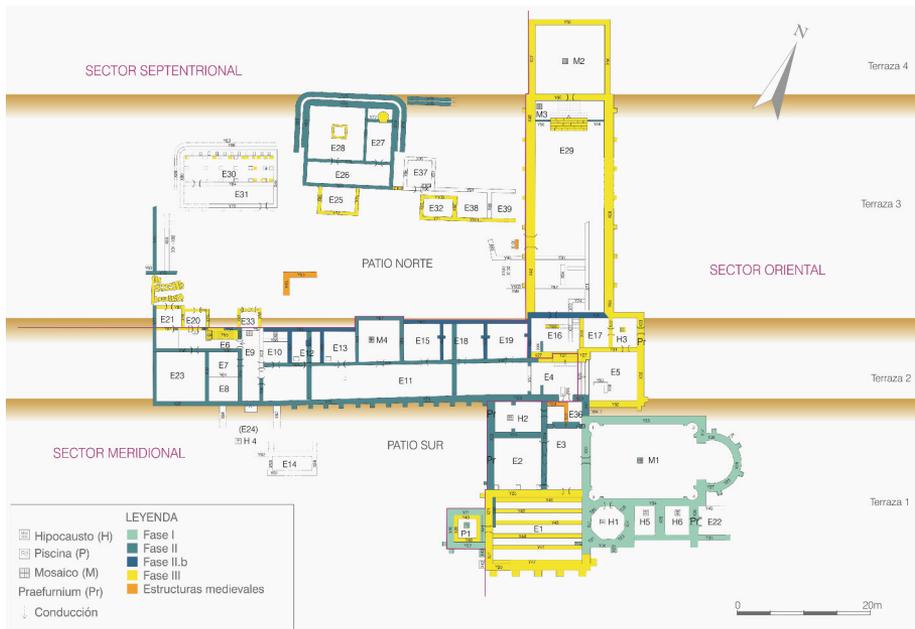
Planta general de la villa de Veranes con indicación de sus fases constructivas.
